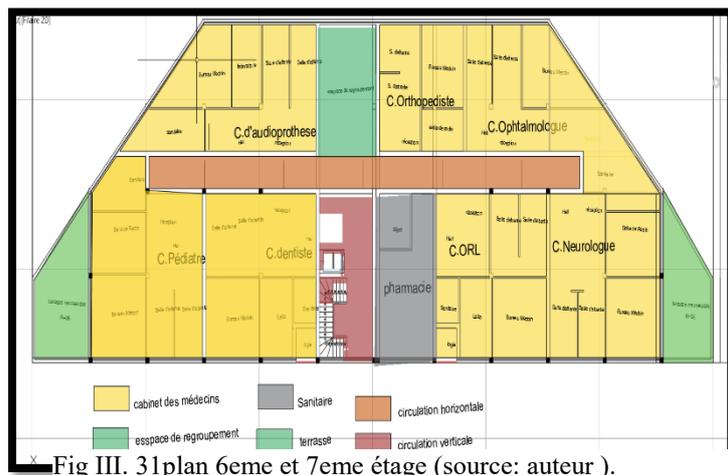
lan 6^{eme} et 7^{eme} étage (source: auteur).
